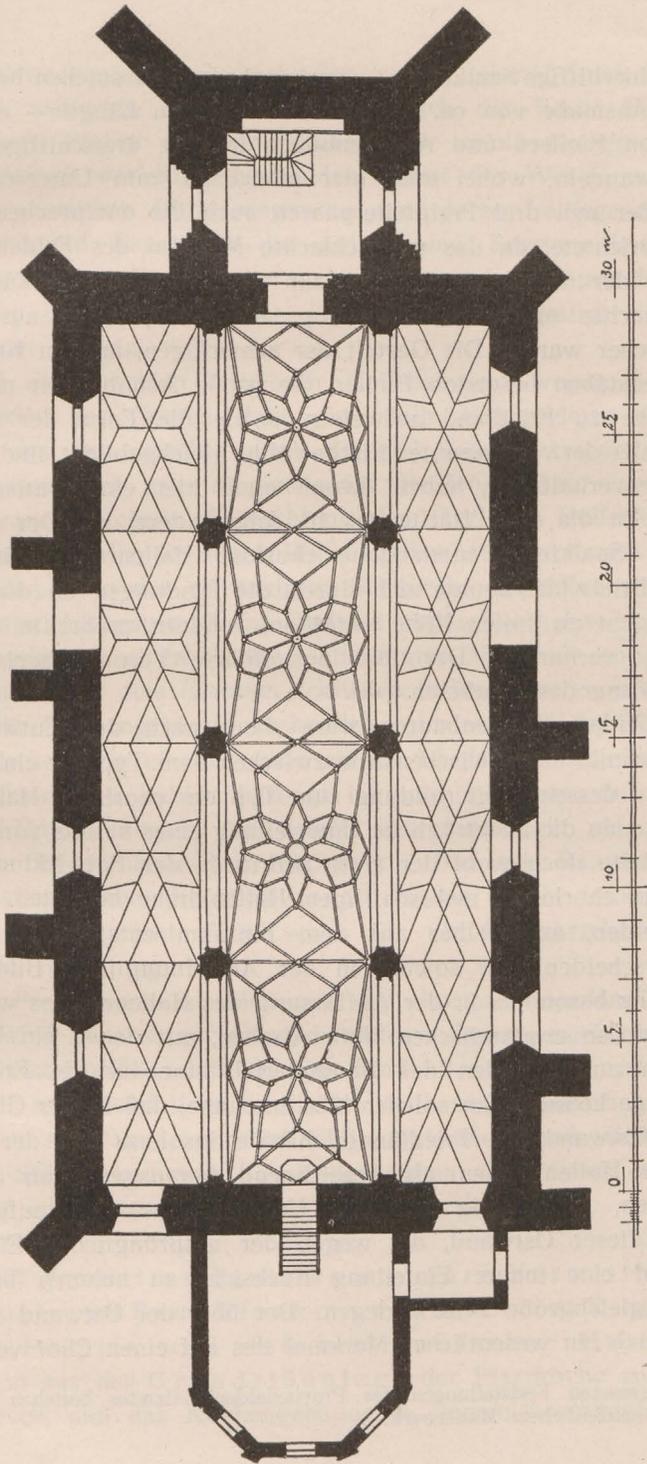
Pfarrkirche zu Labiau, Grundriß.
